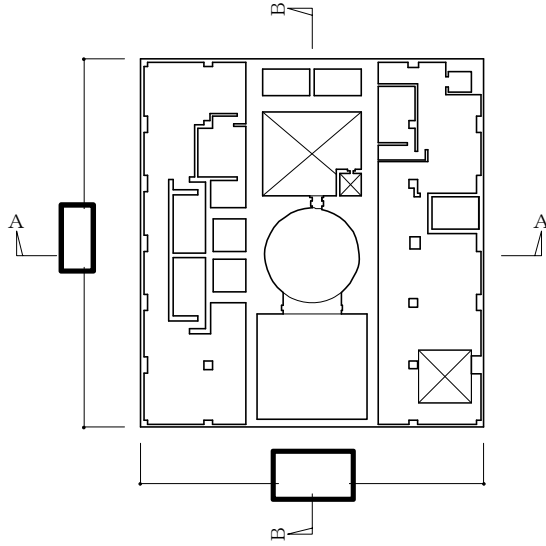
(1/2)  の概略平面図 (EL. 38.8 m)
